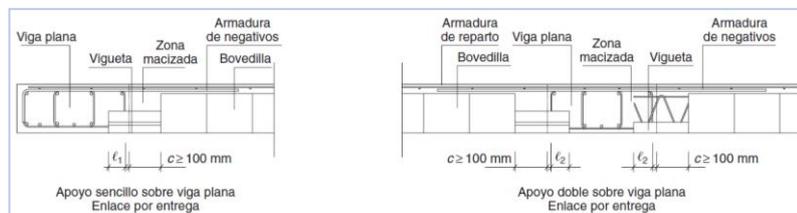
y 28. Apoyo sobre viga plana. Enlace por entrega
